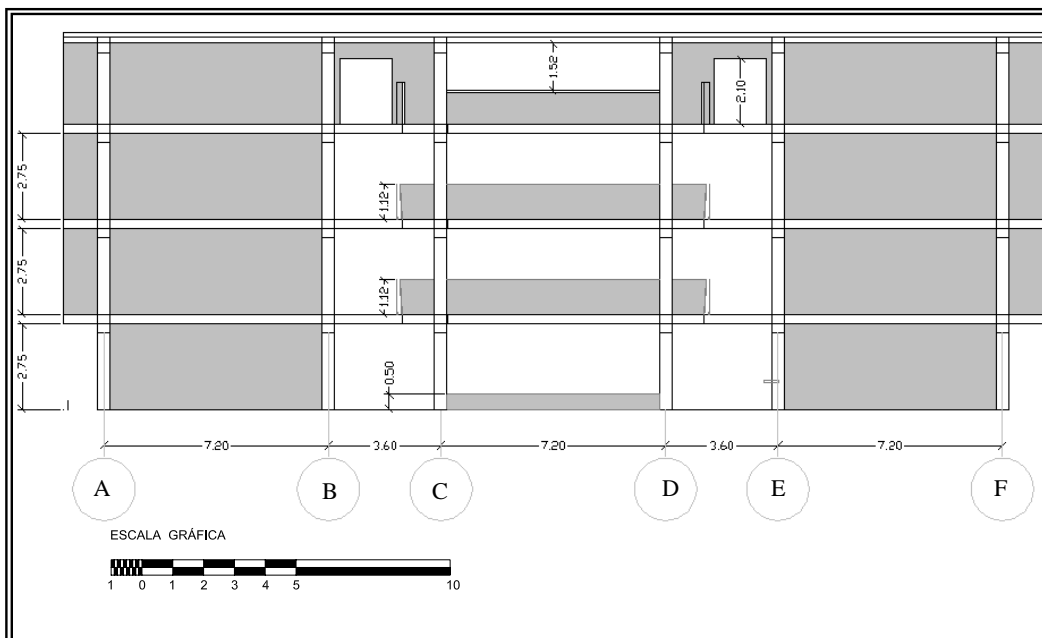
Pórtico 3 (norte-sur) mostrando las paredes de mampostería y la longitud efectiva de columnas
